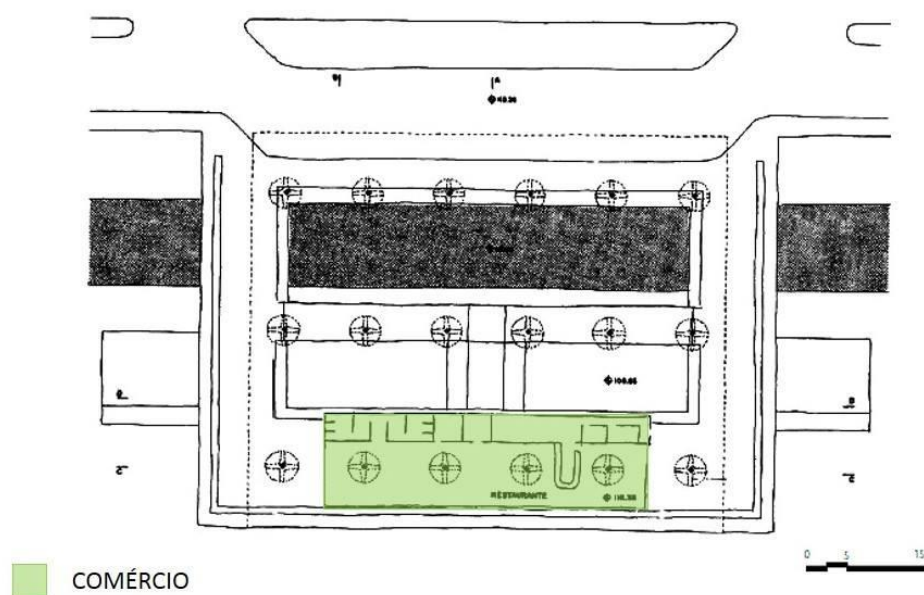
Planta pavimento superior. Fonte: Adaptado www.arquiteturabrutalista.com.br
